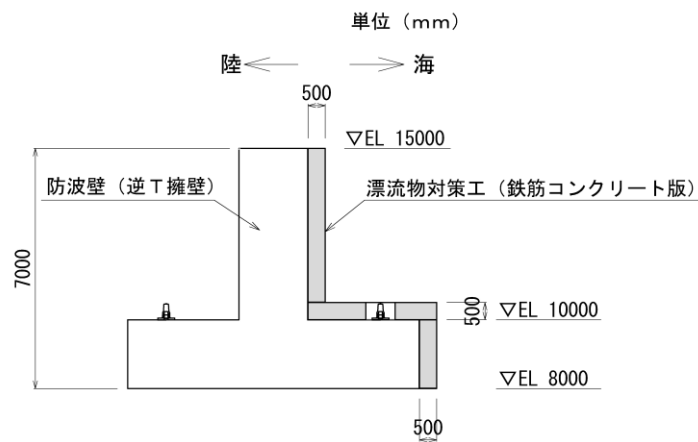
(3) 漂流物対策工 (鉄筋コンクリート版) の構造概要図 (断面図)
